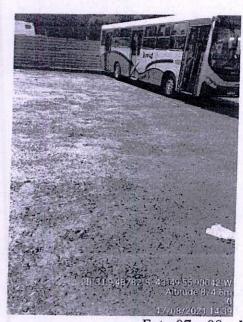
e 08 - Vista da pavimentação do pátio da empresa
